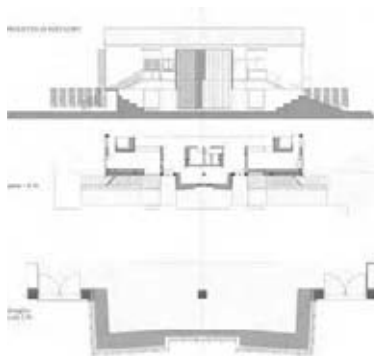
Villaggio Santa Rosalia, il sistema delle logge dell'edificio O, piante e prospetti, progetto
